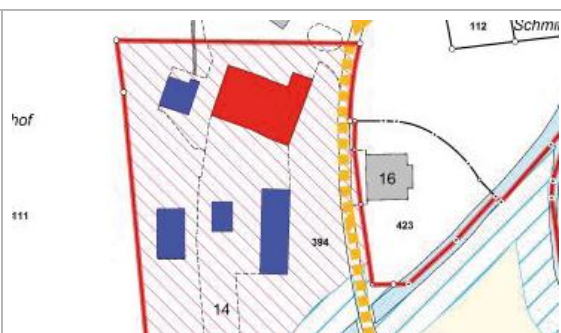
Bebauungsplan neu, Kulturdenkmäler gem. kant. Bauinventar.
